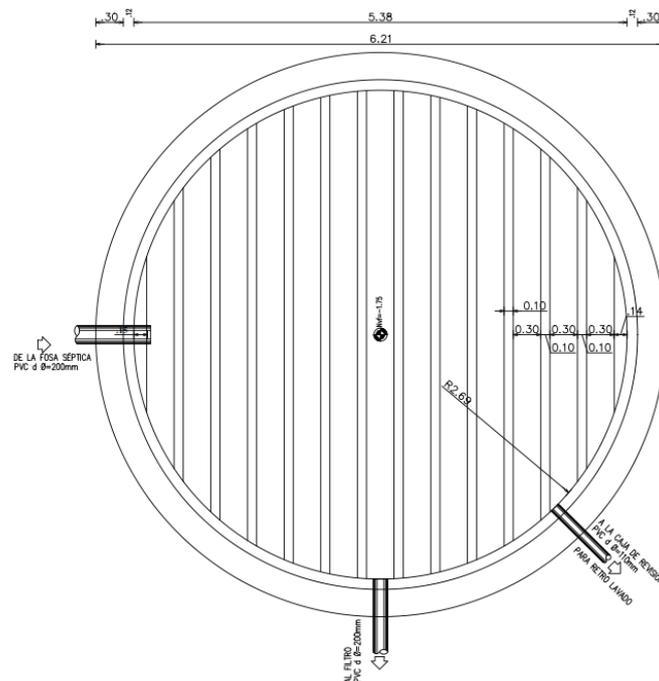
Vista en planta del filtro anaerobio de flujo ascendente (FAFA) de la PTAR.
